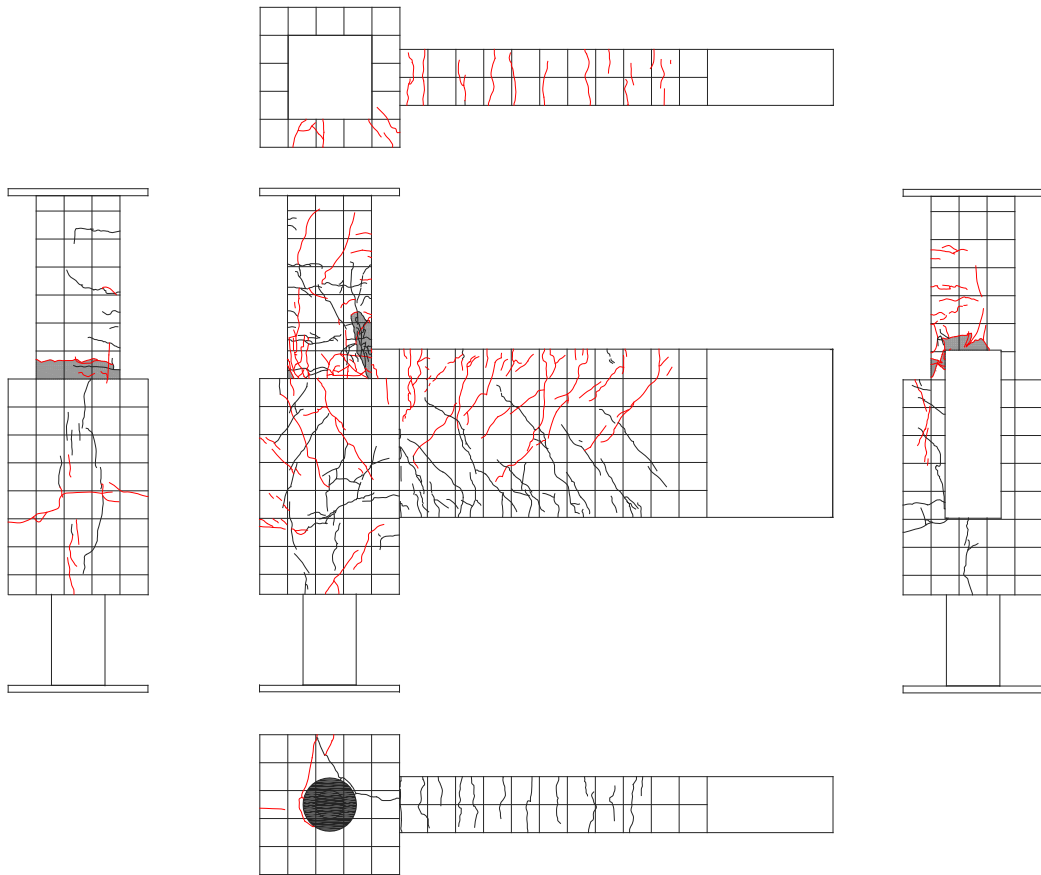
試験体 A-6 ひび割れ状況 (7Cycle)
